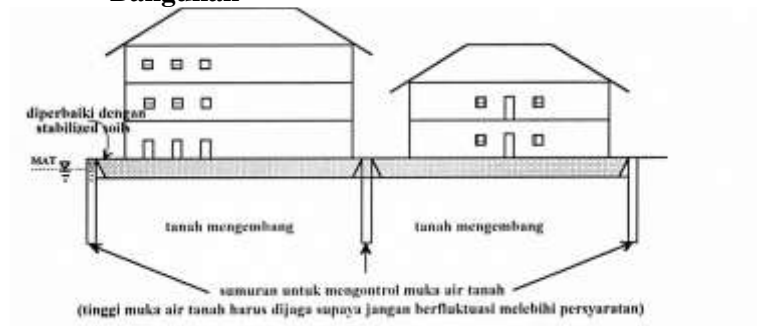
Simulasi Pondasi Sumuran/Tiang Strauss sampai di Bawah Lapisan Tanah Kembang Susut (Mochtar,2000)
